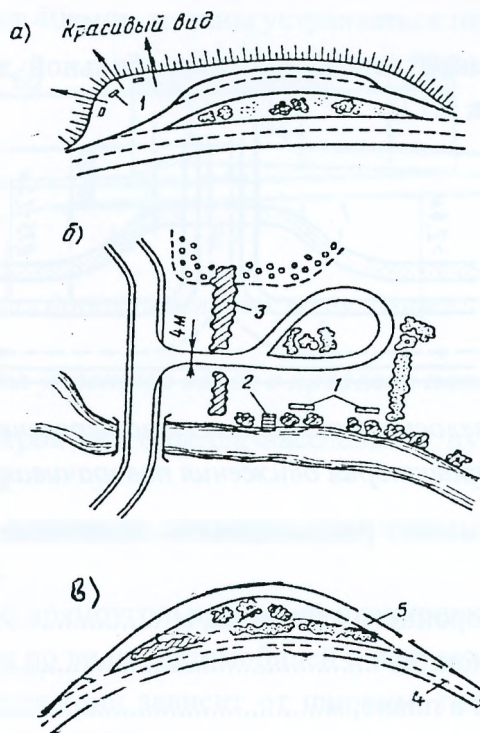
Примеры планировки площадок отдыха: а – типичная планировка площадки у места с красивыми видами; б – площадка отдыха у реки; в- использование для площадки отдыха брошенного при увеличении радиуса кривой участка дороги; 1 – скамейки; 2 – лестница к реке; 3 – живая изгородь; 4 – новый участок дороги; 5 – брошенный при реконструкции участок дороги.
